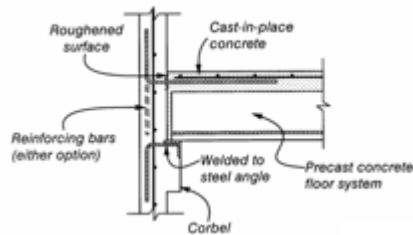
Muro continuo con ménsula reforzada (fib, 2003).
